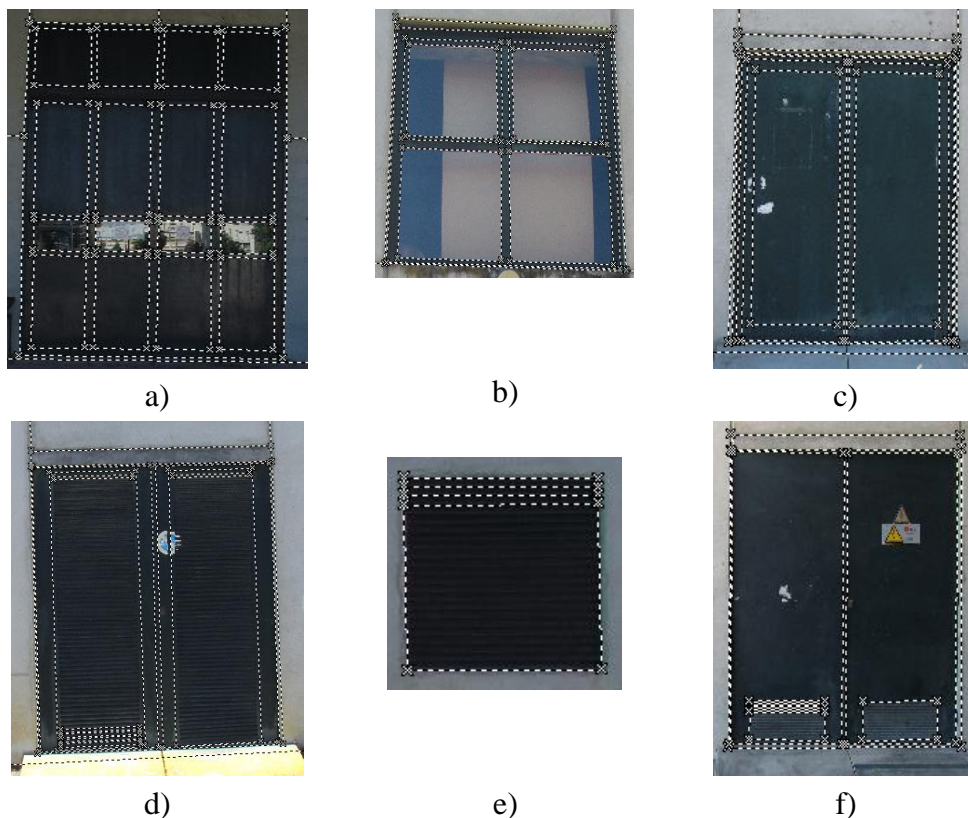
Traçado dos pormenores das portas e janelas: a) porta central, b) janela 1, c) porta exterior do lado direito, d) porta exterior do lado esquerdo, e) janela 2 e f) porta na reentrância
